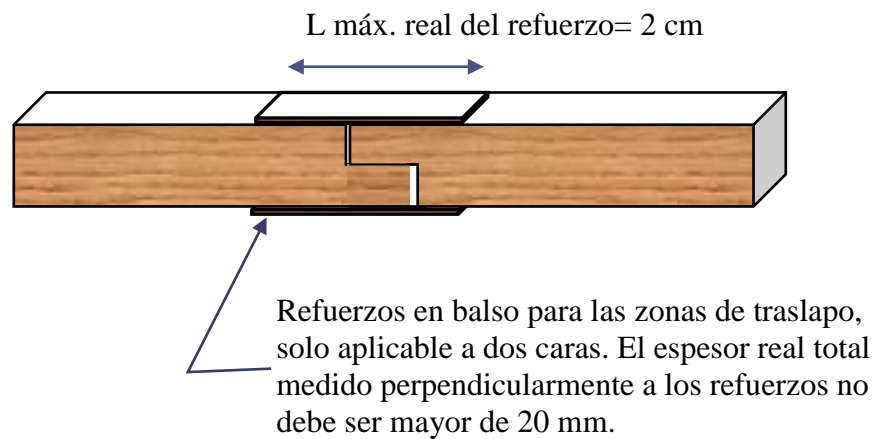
Refuerzos en las zonas de traslapos entre piezas de balso.
